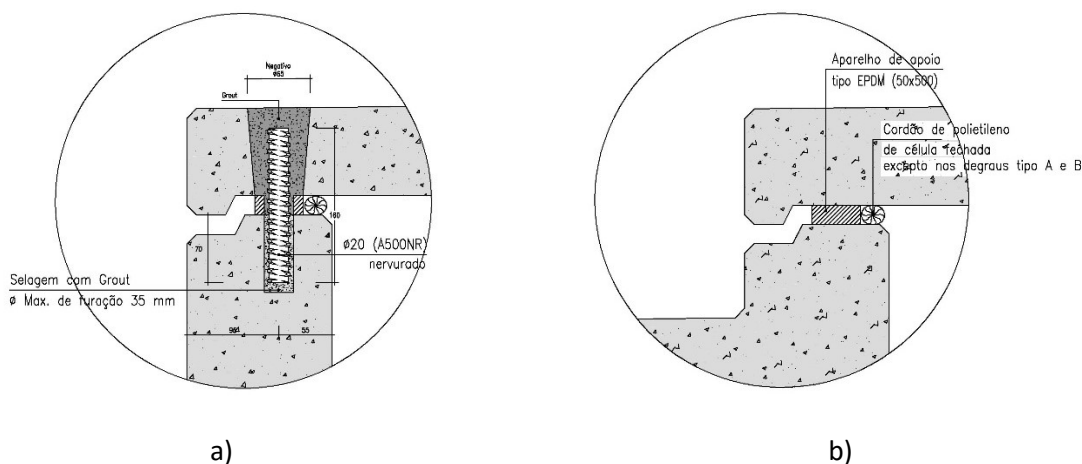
Pormenores de ligação entre degraus: a) ligação rígida (pormenor 1, Figura 4.8a); b) ligação flexível (pormenor 2, Figura 4.8b).
